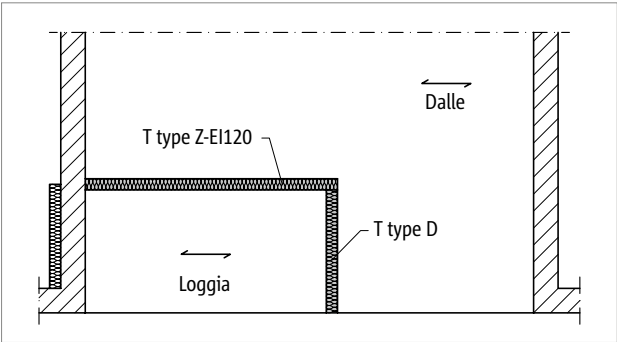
Schöck Rutherma® T types D et Z : dalle portée sur deux appuis
